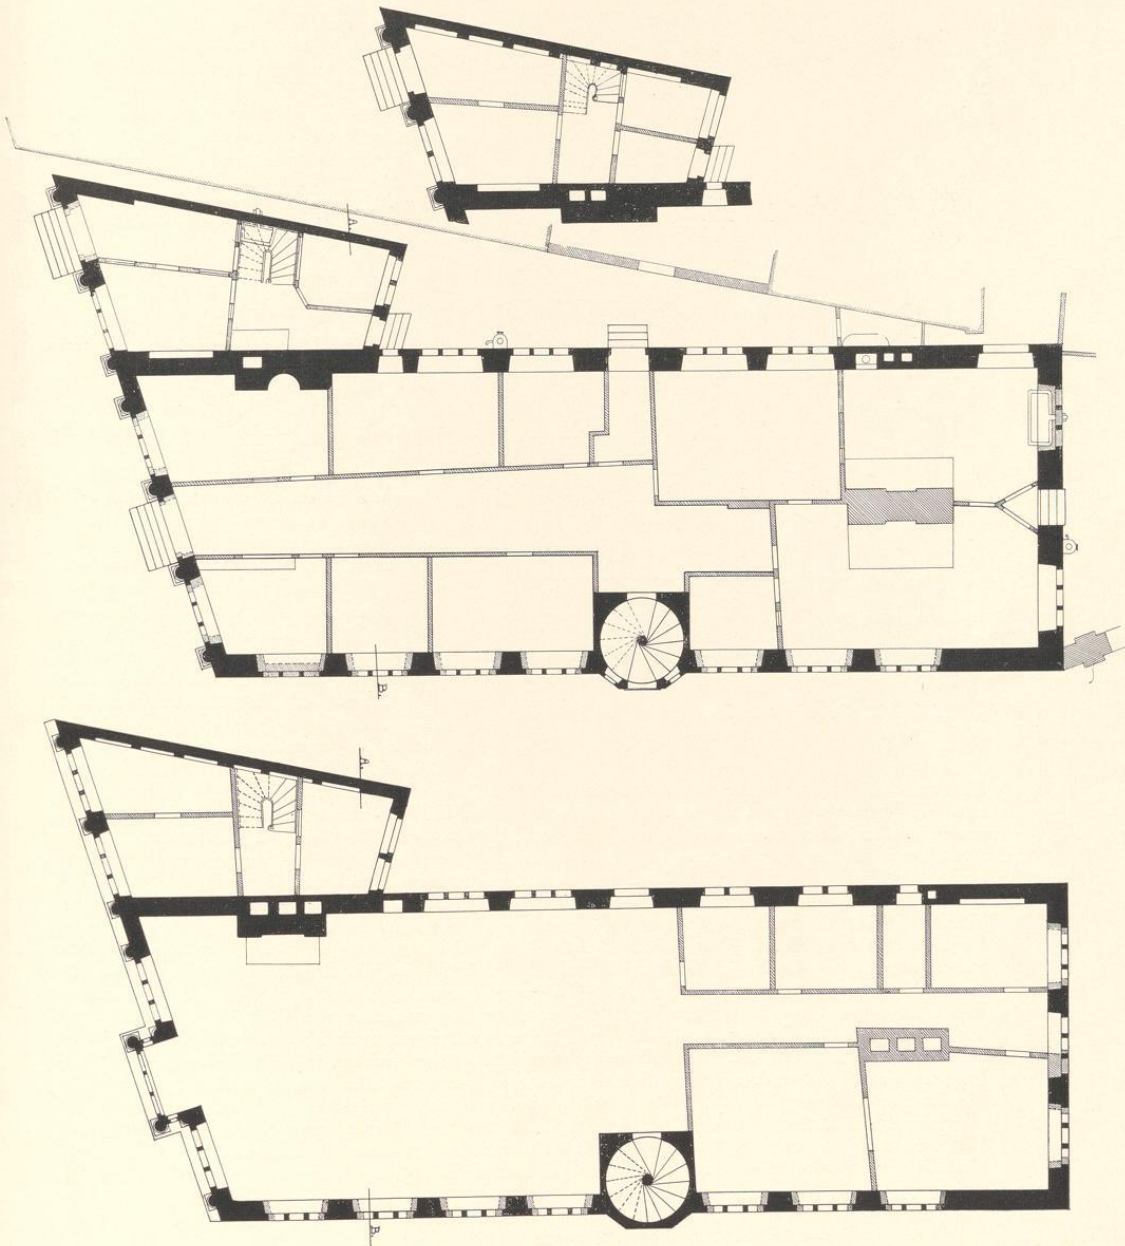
und 772. Grundrisse des Erd- und Obergeschosses der Stadtlege (mit Zwischengeschoss) und des Stadtkellers; Maßstab 1 : 200
